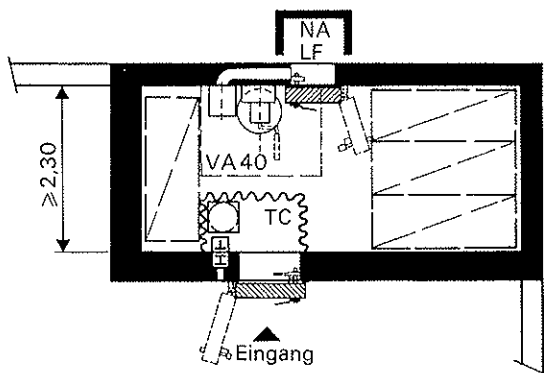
«Längliche» Grundrissform für 5 bis 7 Schutzplätze (minimale Bodenfläche 8 m^2)
